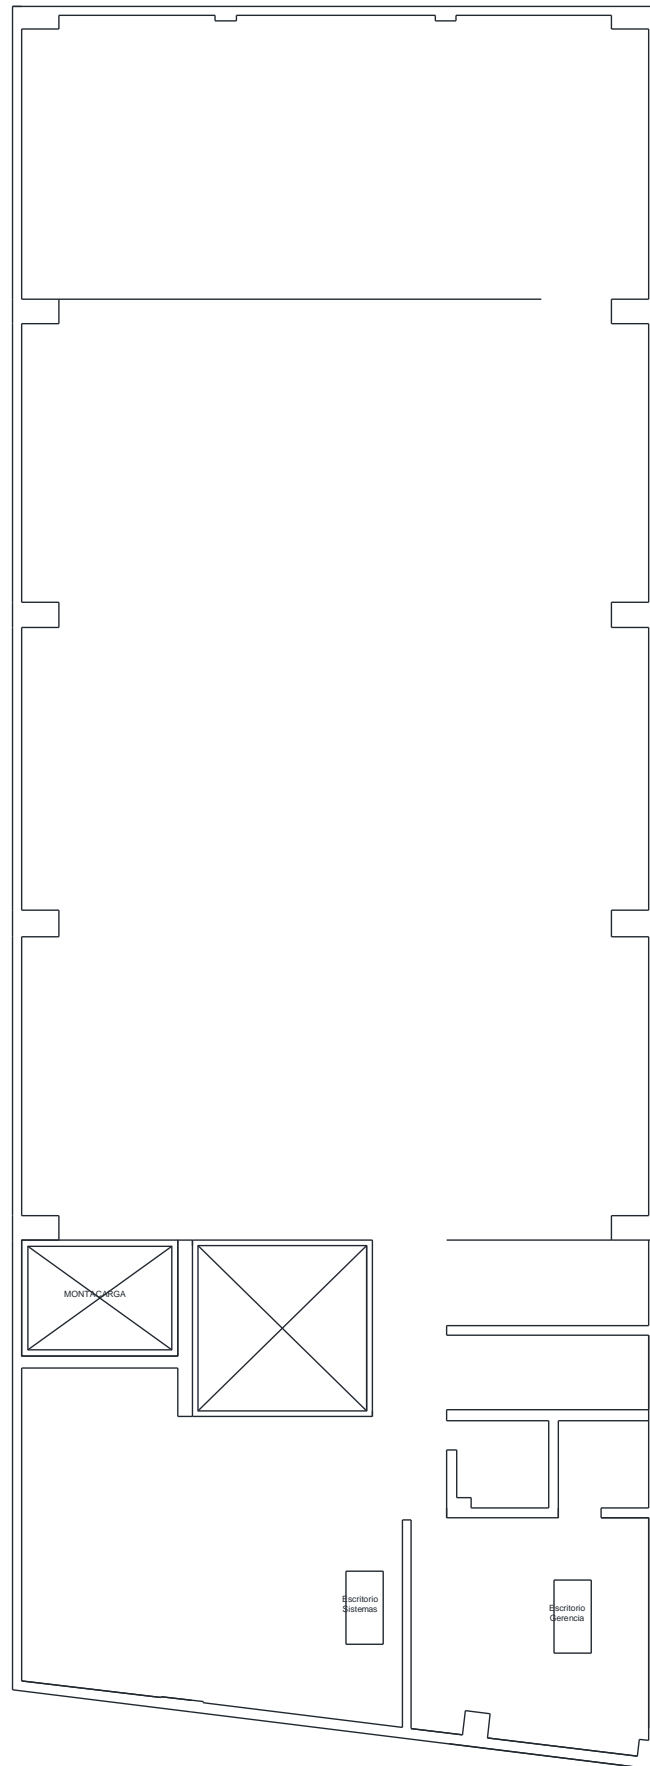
Layout propuesto de la planta 1 - segundo piso.
